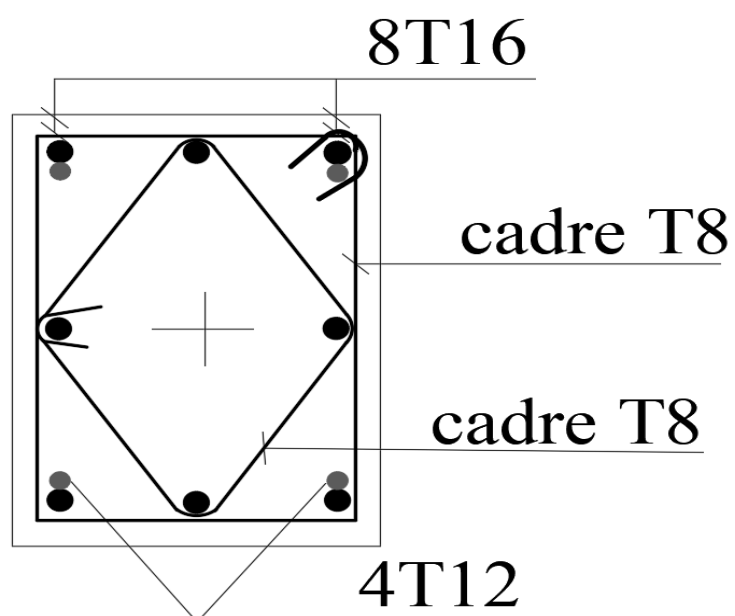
Ferrailage du poteau de section (35x40) cm²
